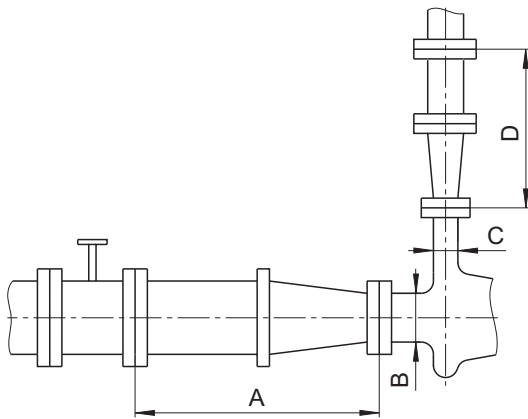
Gerade Rohrleitungslängen vor und nach der Pumpe (empfohlen)
